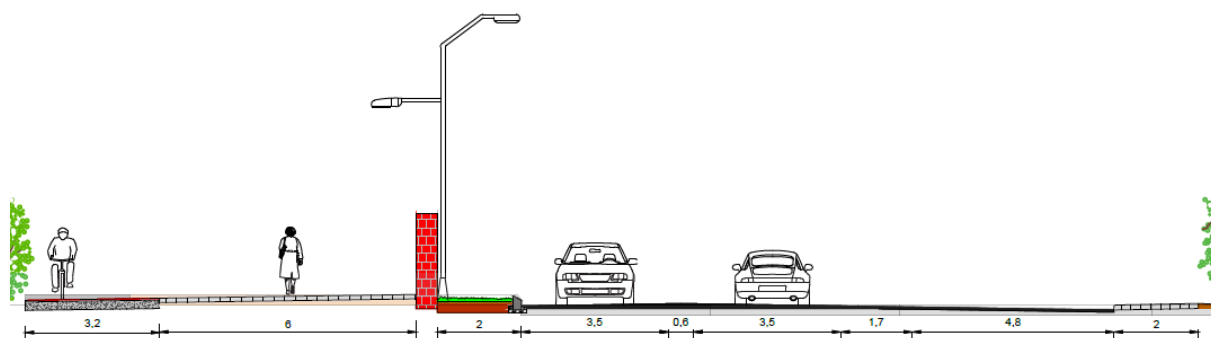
Sección 4.3. Fuente: Elaboración propia a partir de AutoCad.
